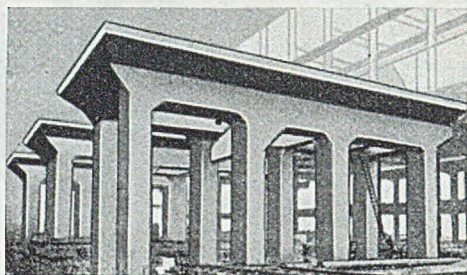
Stahlbetonfundamente (aus Rausch: [9] S. 459).
